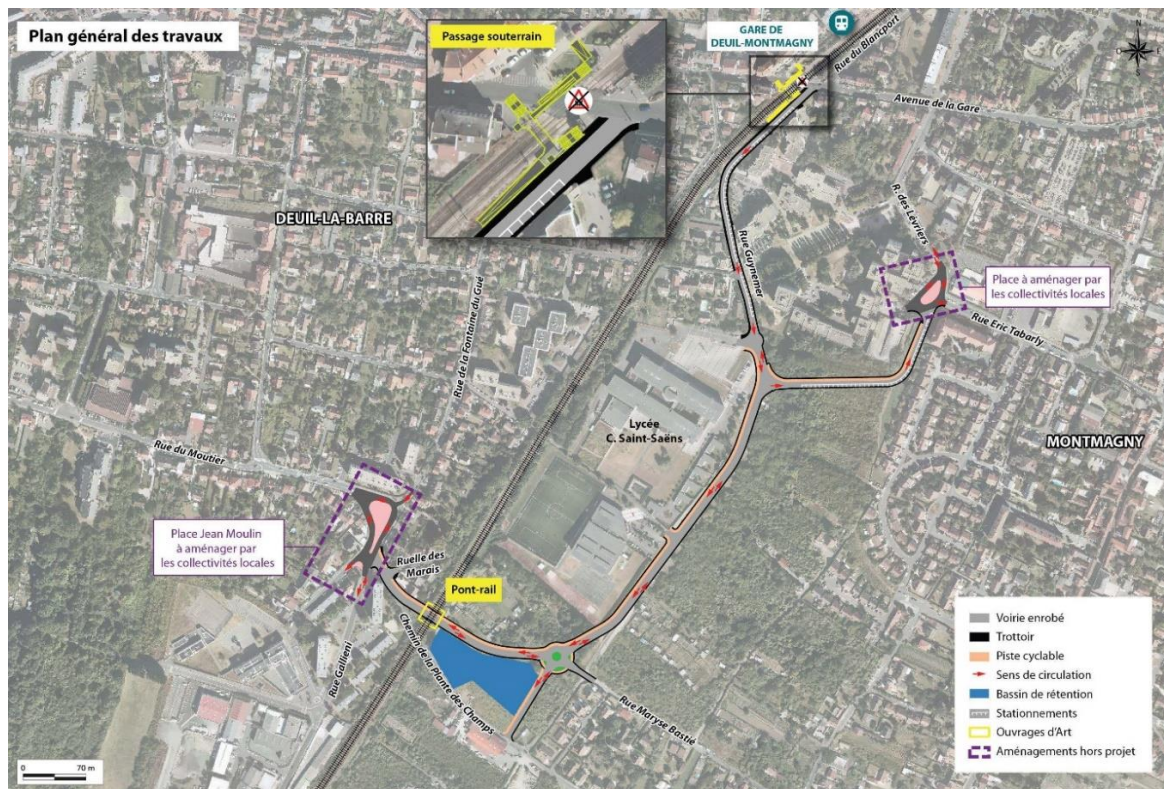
Plan général des travaux. Le PN n°4 se trouve sur l'avenue de la gare. Source : dossier
